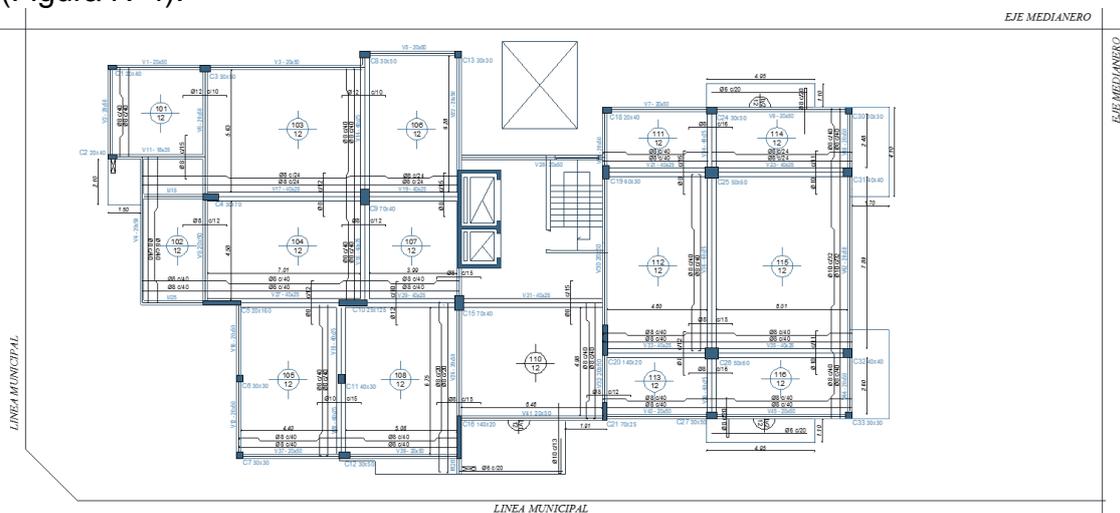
Estructura de planta tipo Edificio Imperial de Concordia
